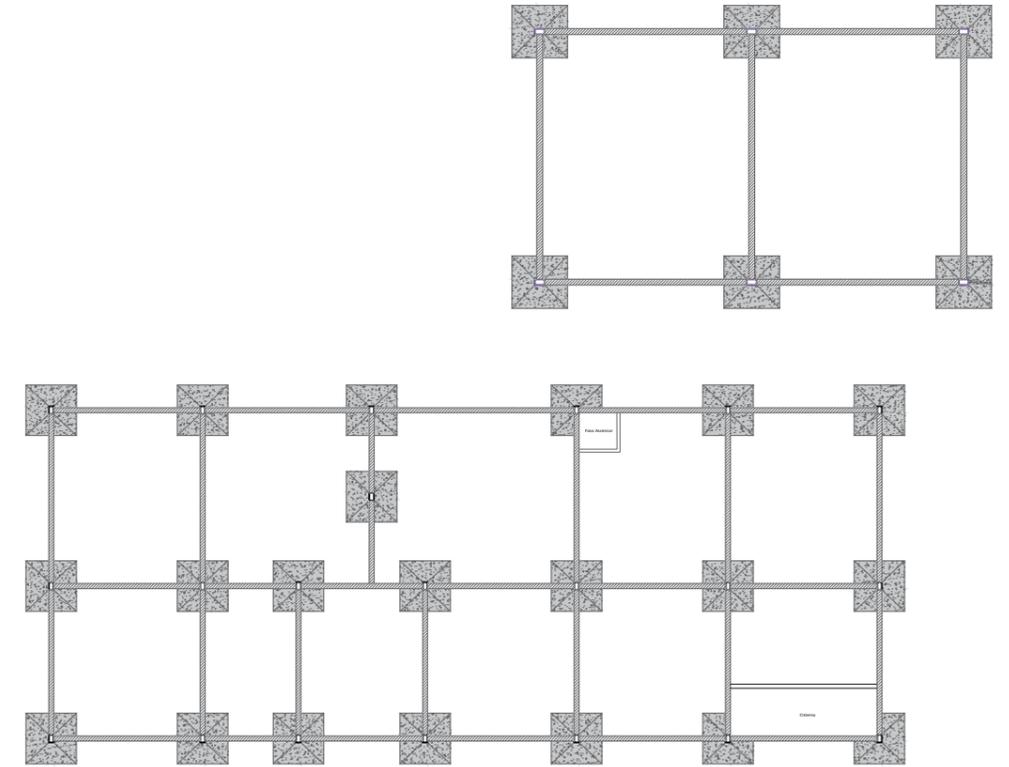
Ccomportamiento de columnas y vigas proyecto
